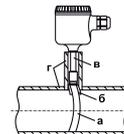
Монтаж датчика ДТС325М: а) хомут; б) пластина-теплообменник; в) арматура датчика; г) теплоизоляционный материал для трубопровода
